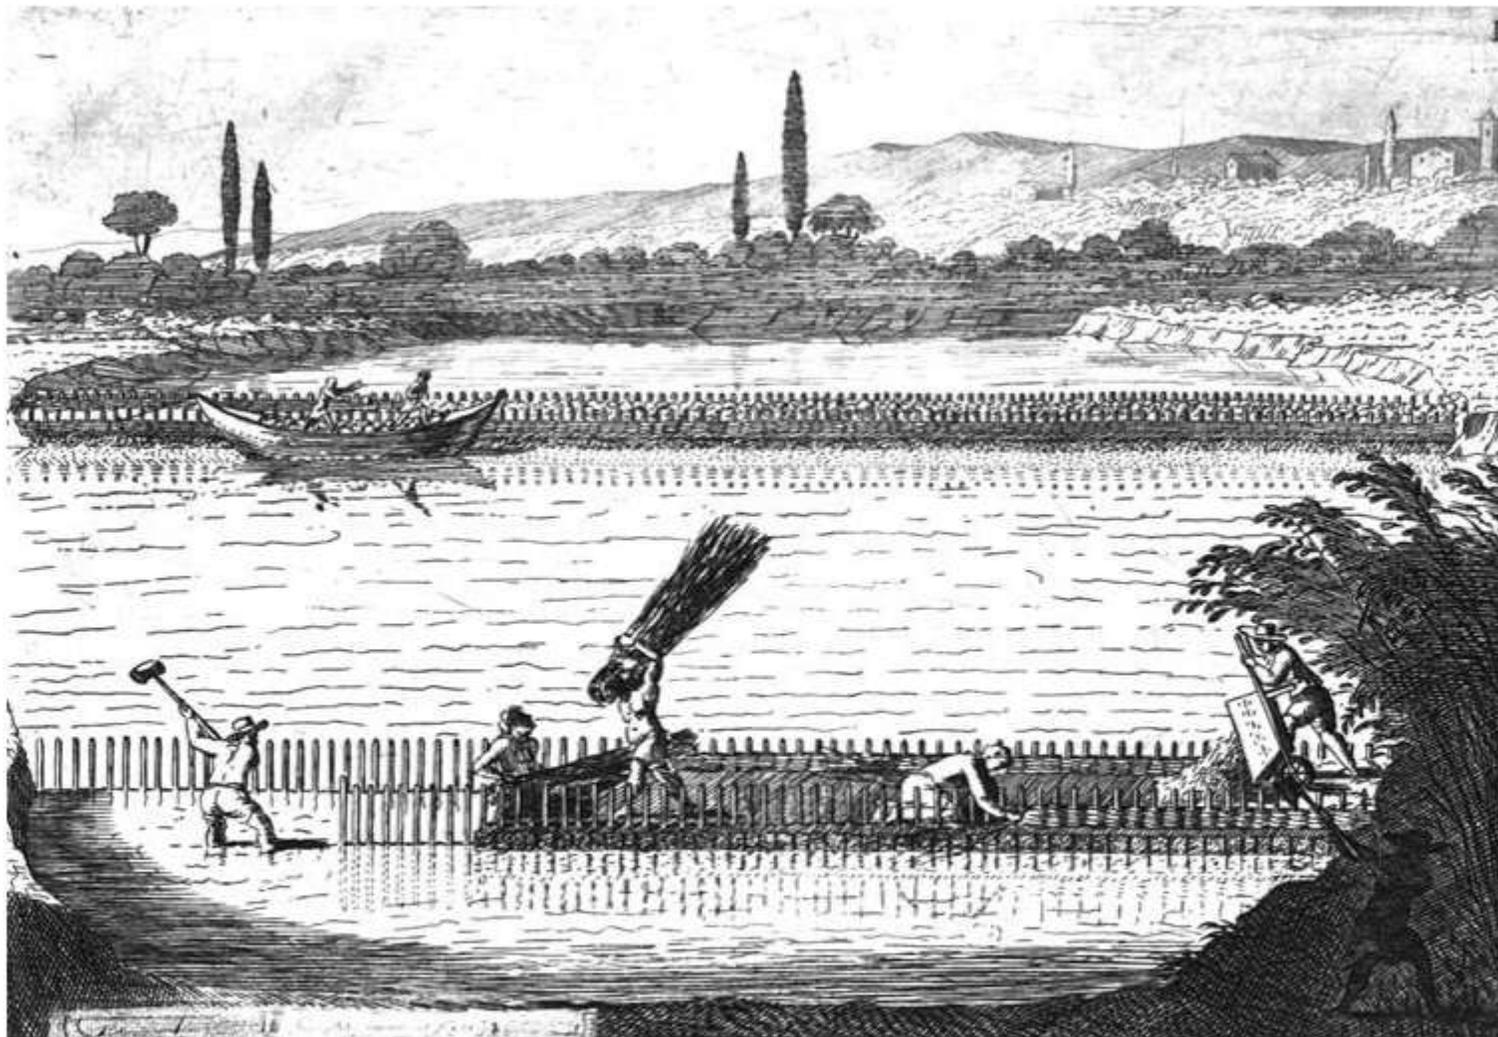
Cornelius Meyer 1685, construction d'ouvrages à base de fascines et tressage pour la navigation. Un ouvrier coupe les saules à droite, un second plante les pieux à gauche, deux mettent en place les fascines, un autre tresse (clayonnage) pour bloquer les fascines et un dernier les couvre de gravier, alors que l'on peut observer une berge érodée au fond.
